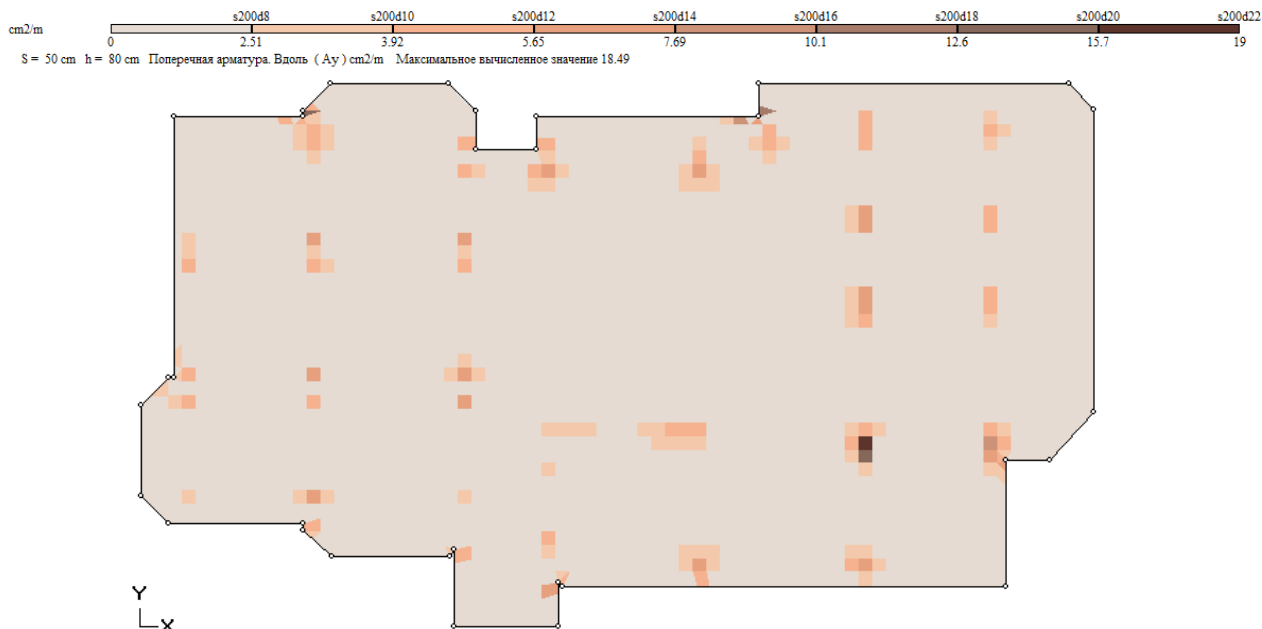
Поперечне армування плити у напрямку осі У
